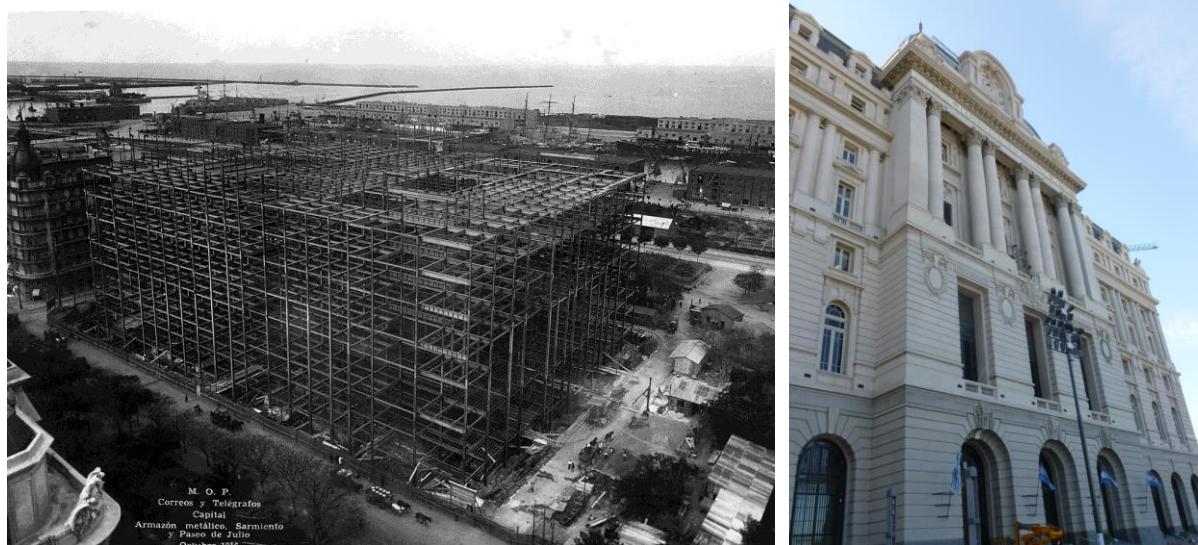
Edificio del Correo Central, construcción de su estructura metálica, 1916 / Central Post Office building, metal frame construction process, 1916 (AGN)
